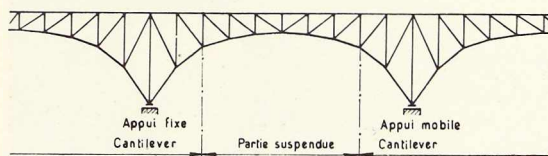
Schéma d'une poutre maîtresse de la travée franchissant la rivière.
